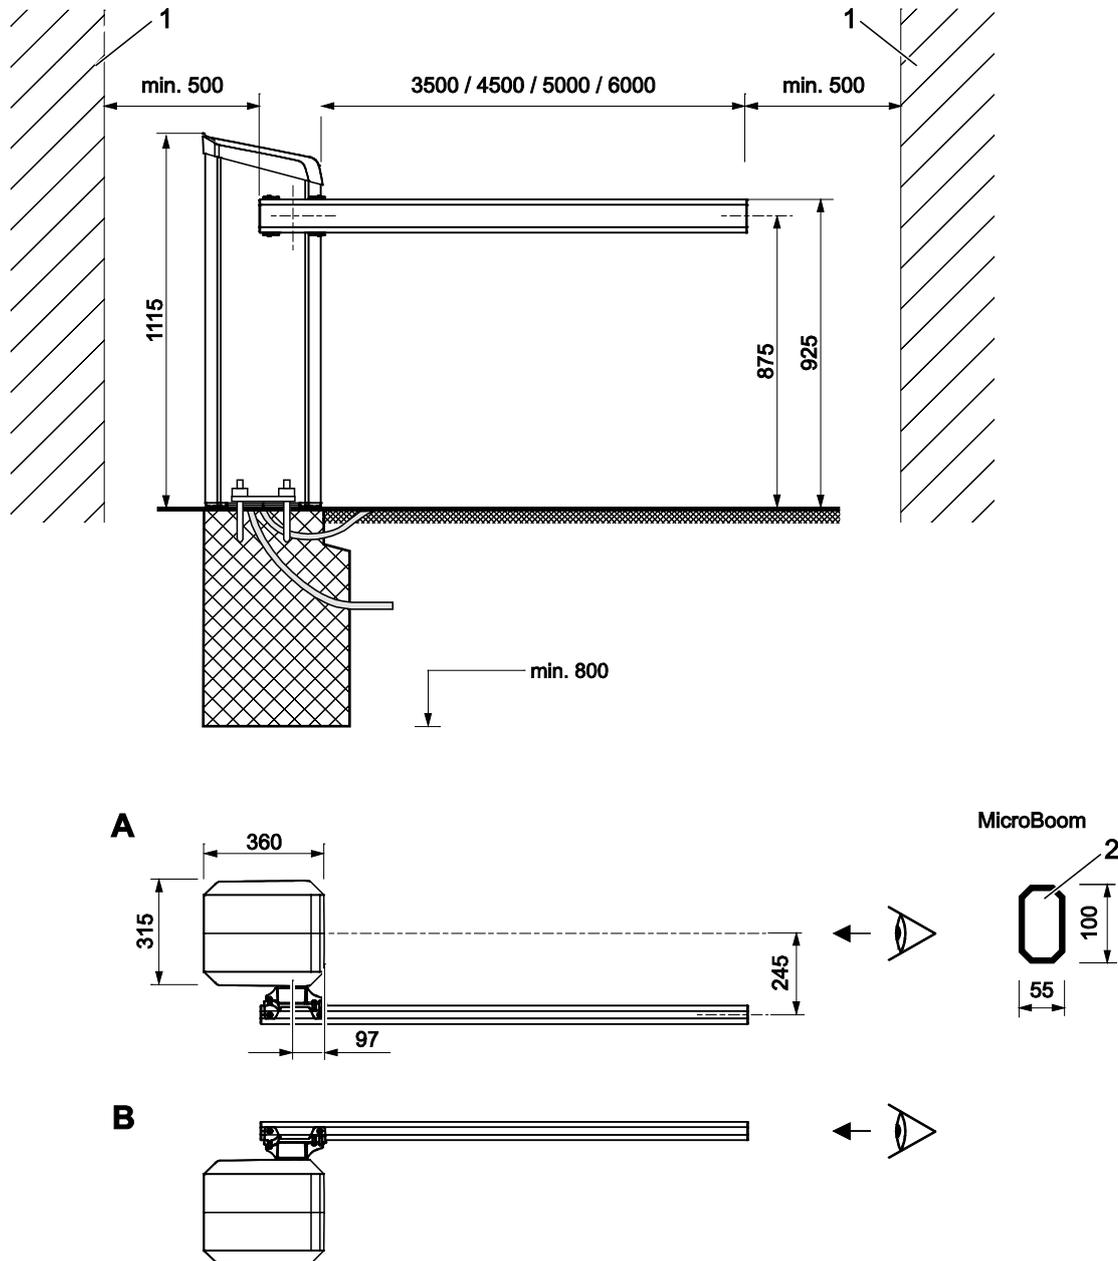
Abmessungen Schrankenanlage und Schrankenbaumprofil – Serie "Access Pro H" (Maße in mm)
